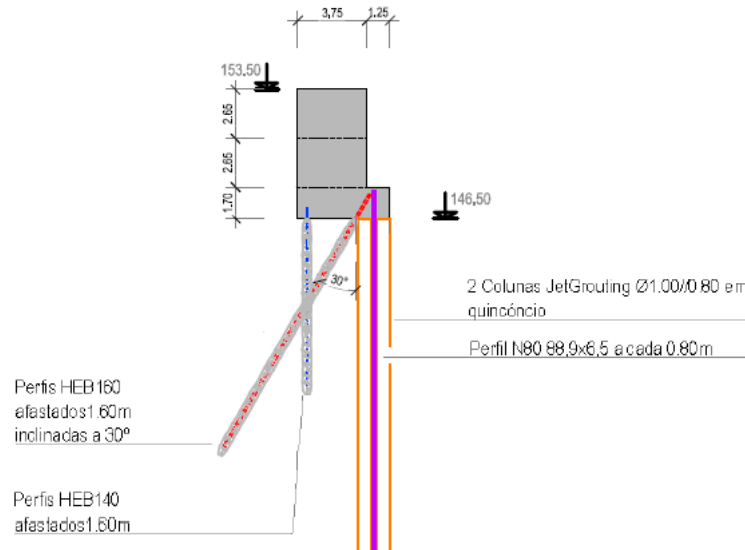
Secção transversal do muro de betão simples da solução executada para as secções Corte 7 e Corte 8 (adaptada de Pinto et al., (2014)).
